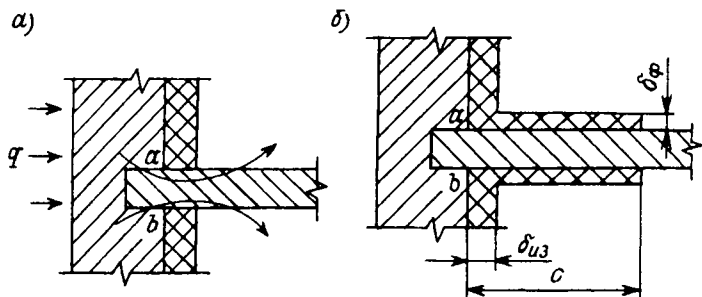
Нарушение непрерывности изоляционного слоя в обычных строительных конструкциях многоэтажных зданий
